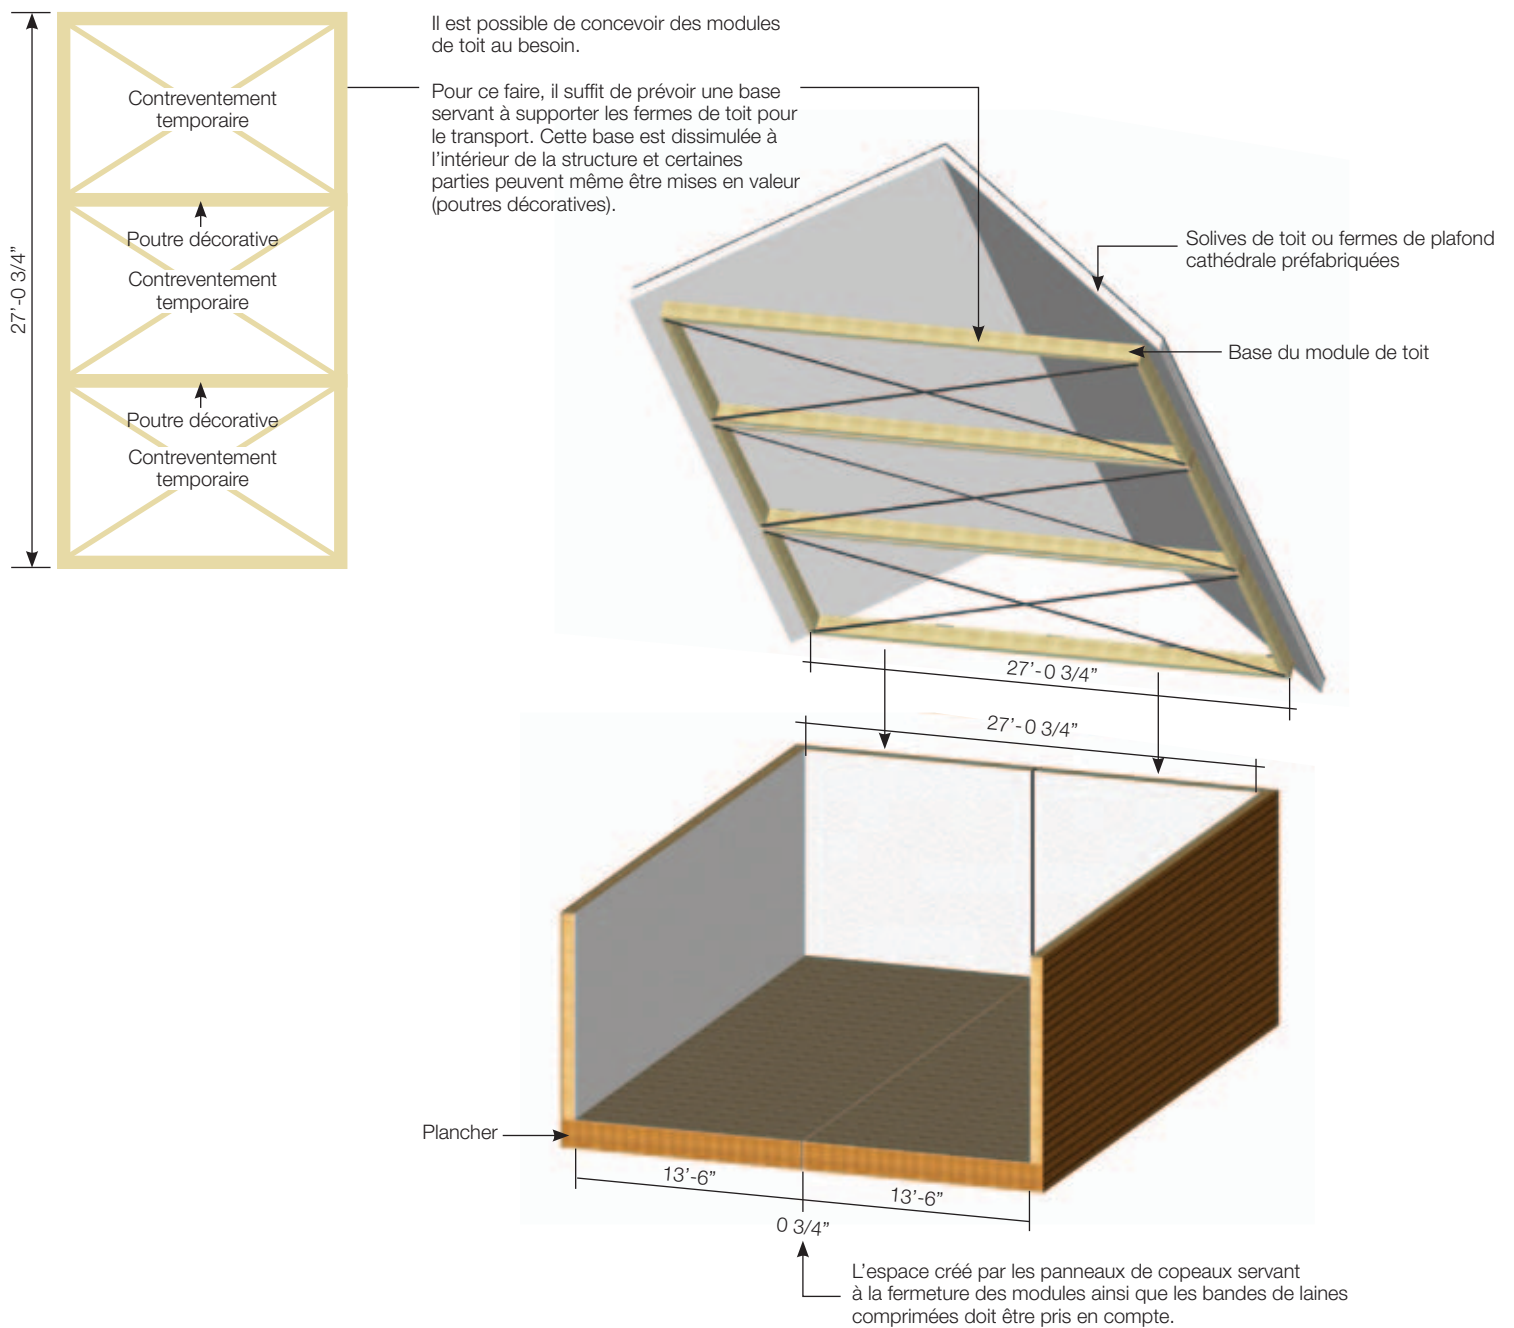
• Contreventement temporaire d'un module sans plancher
